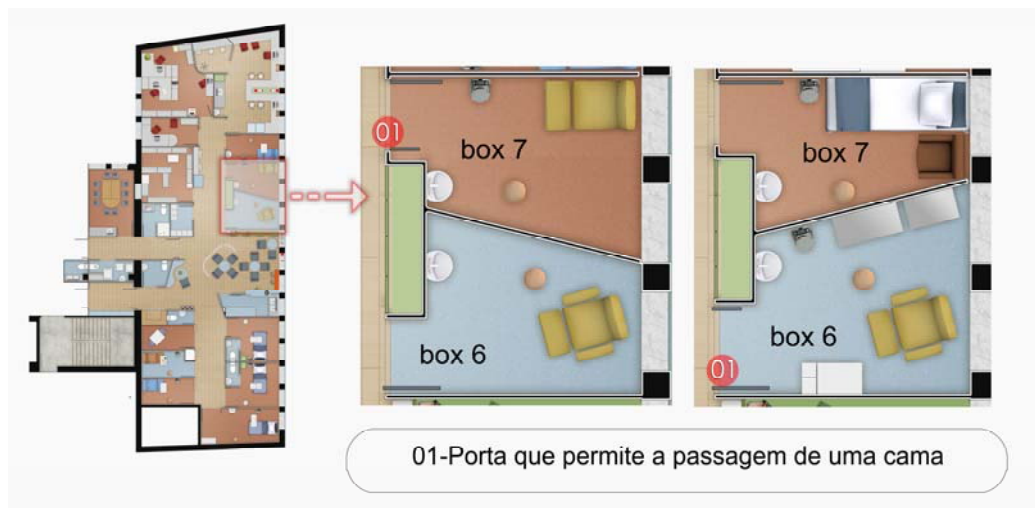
Planta do anteprojeto final e alterações nos boxes 6 e 7 do anteprojeto final para o projeto executado
